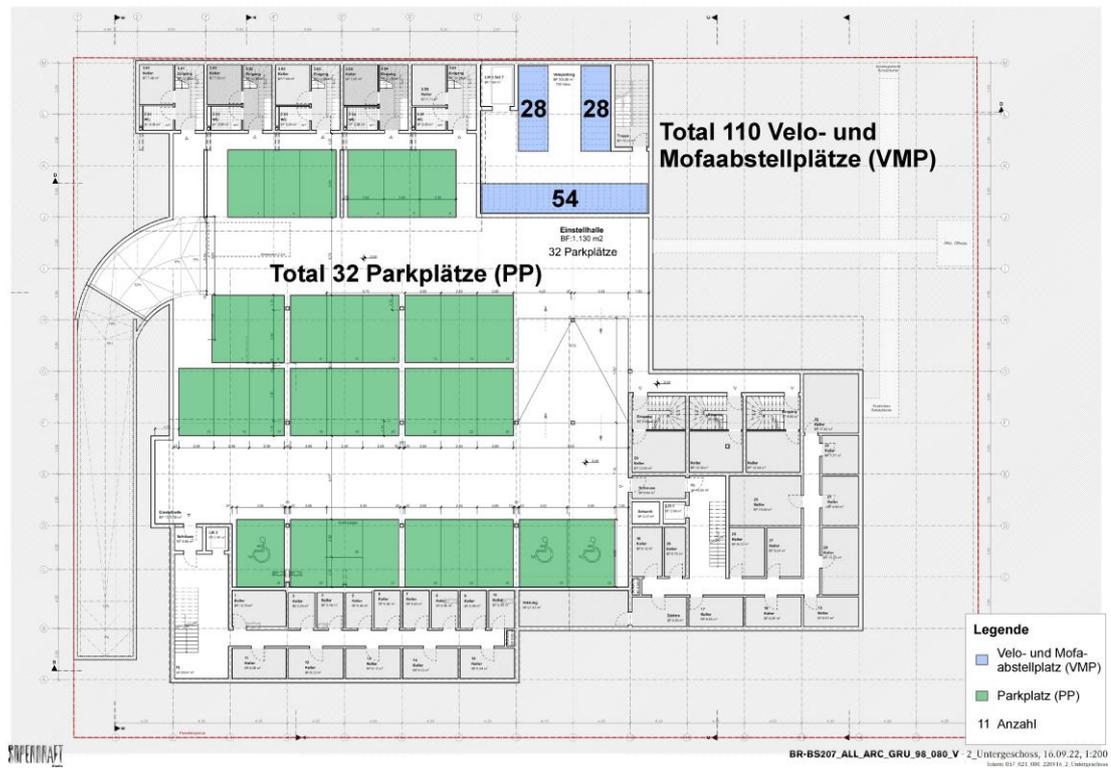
Plan 2. Untergeschoss mit Parkgarage für Personenwagen/Velos [2]
